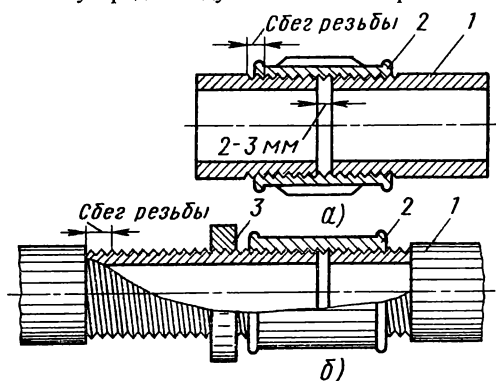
Соединение труб с помощью муфт: а — с короткой резьбой; б — с длинной резьбой; 1 — труба; 2 — муфта; 3 — контргайка
